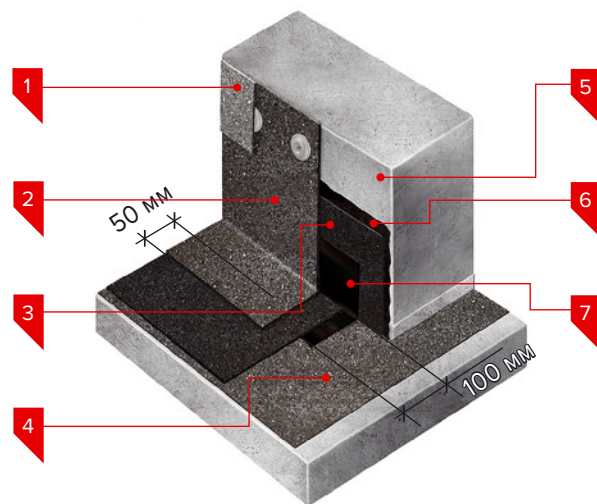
Техноэласт Фундамент TERRA с механической фиксацией. Обустройство внутреннего угла без применения галтели в зоне подошвы фундамента:
